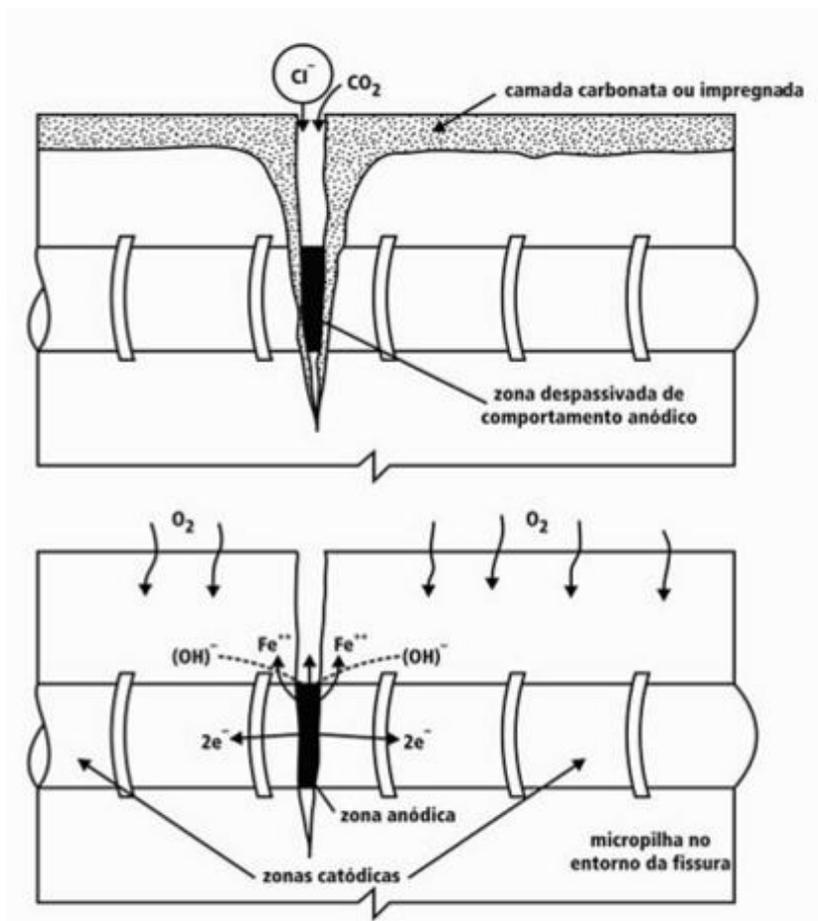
Influência teórica das fissuras sobre a corrosão das armaduras
